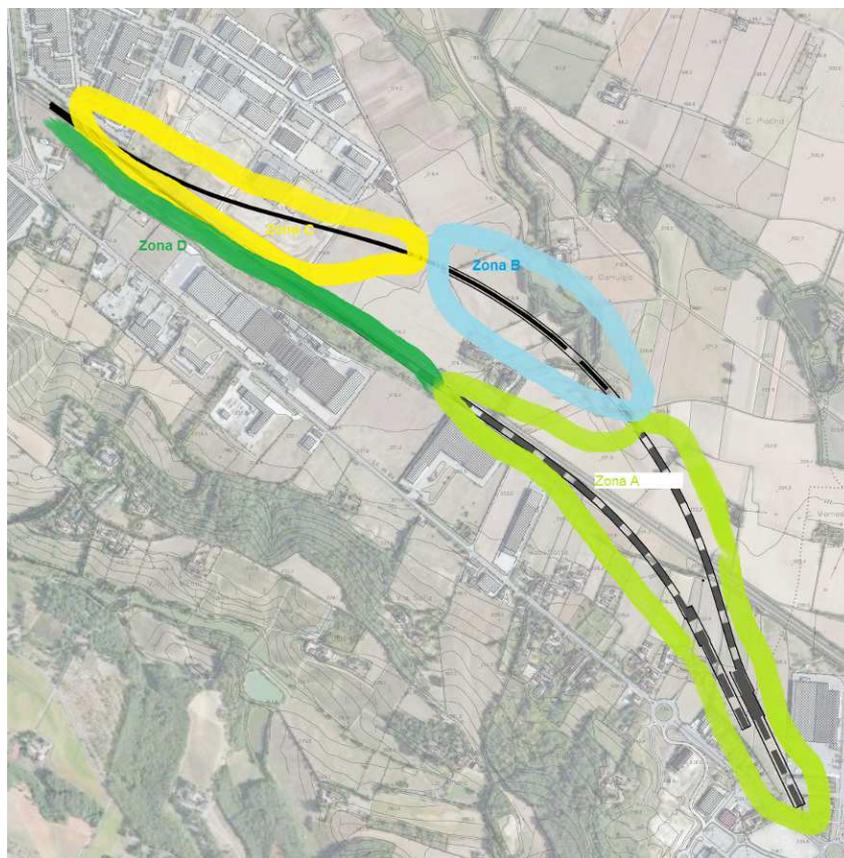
Schematizzazione delle aree - Stralcio della Tavola di progetto
